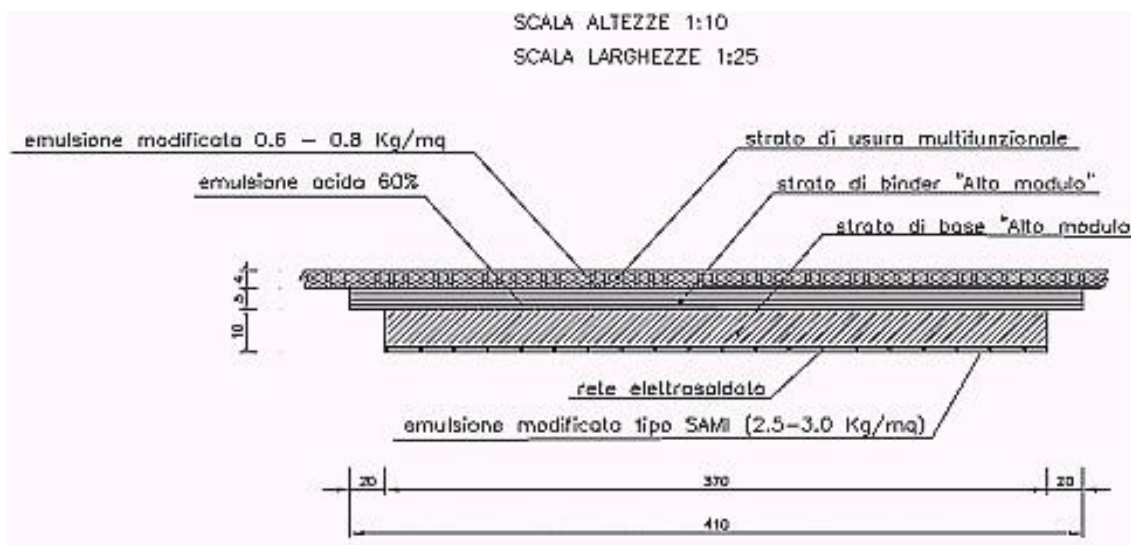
Sezione di pavimentazione rinforzata: rete al di sotto della base.
